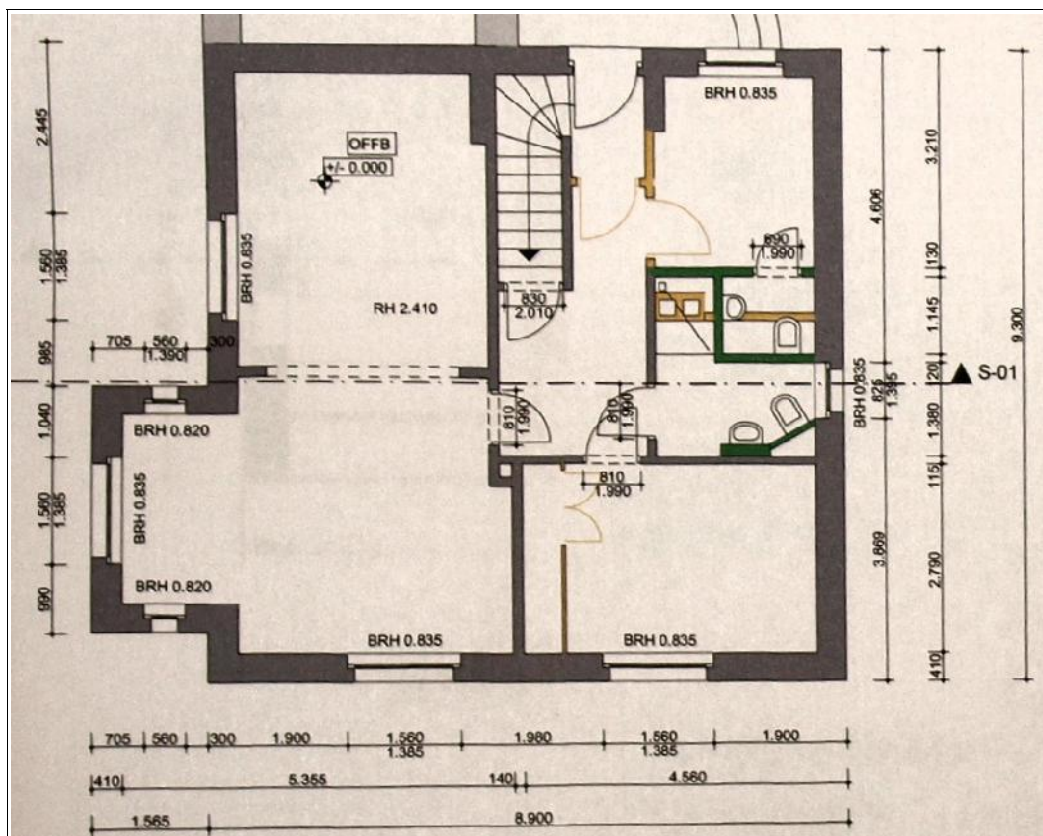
Grundriss Erdgeschoss (EFH)
